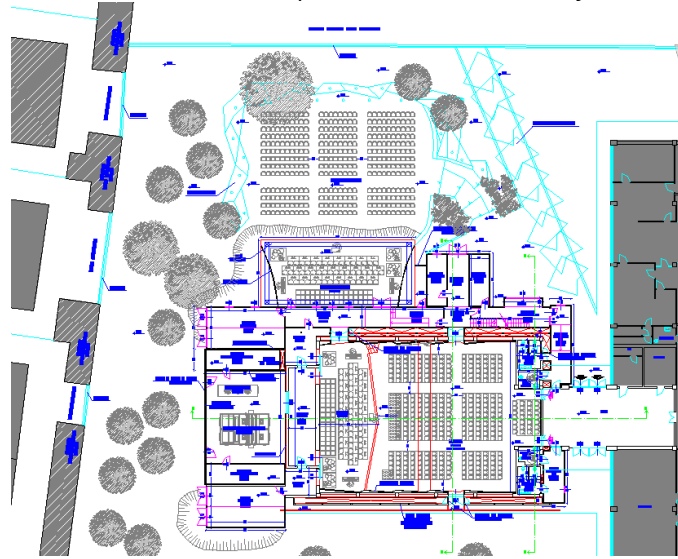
Planimetria della zona in cui è collocato l'Auditorium Guicciardini
